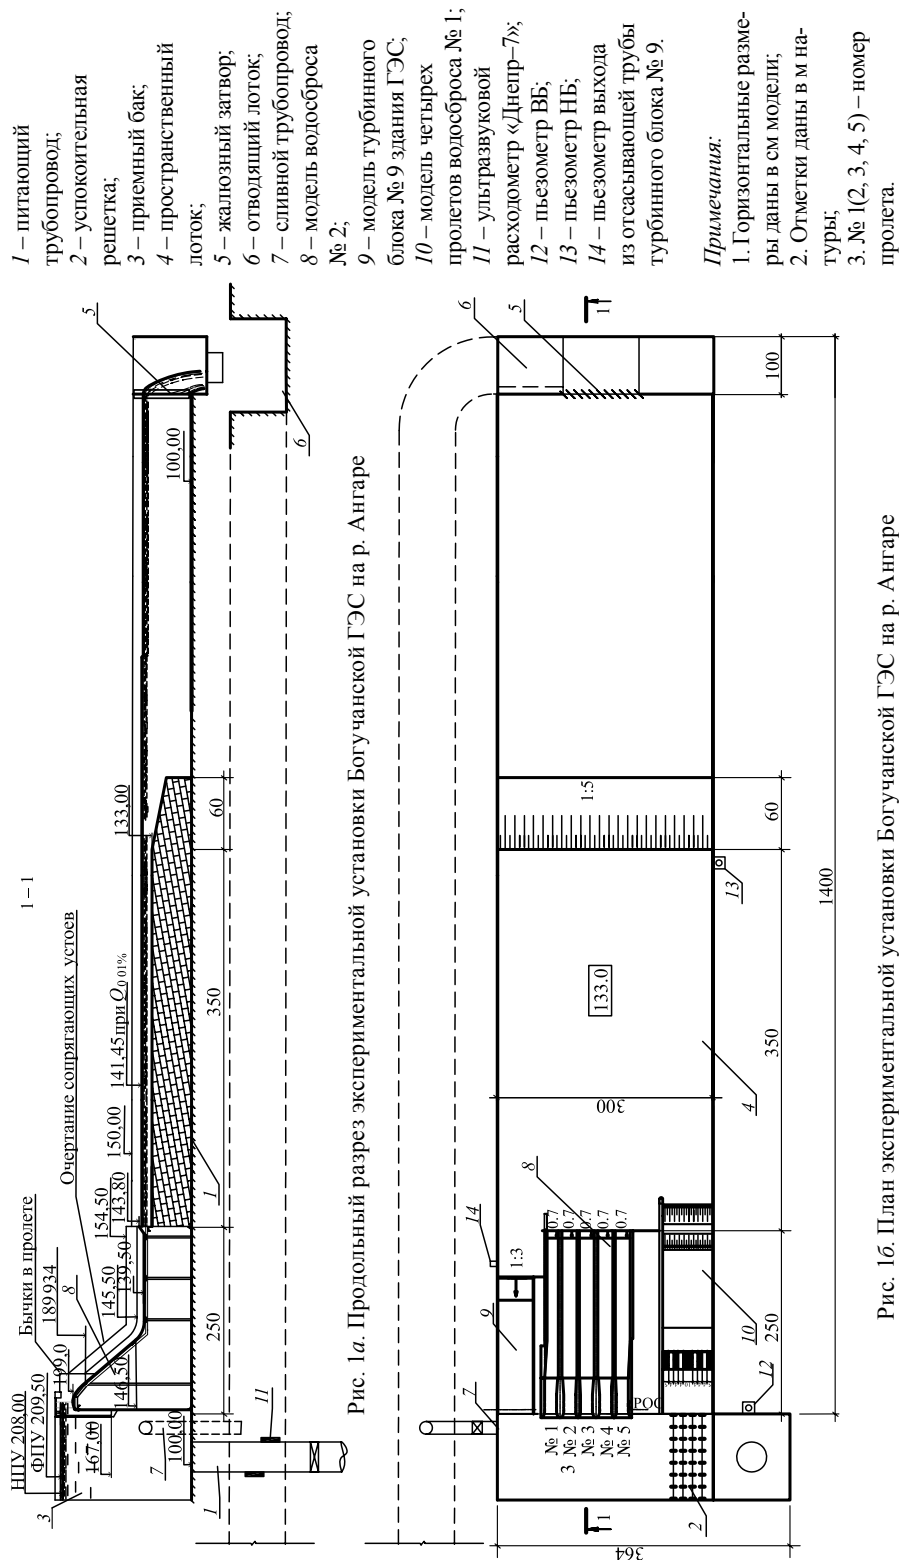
План экспериментальной установки Богучанской ГЭС на р. Ангаре
